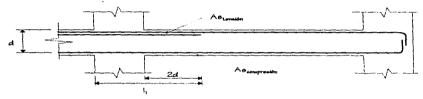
Requisitos de refuerzo longitudinal en vigas
